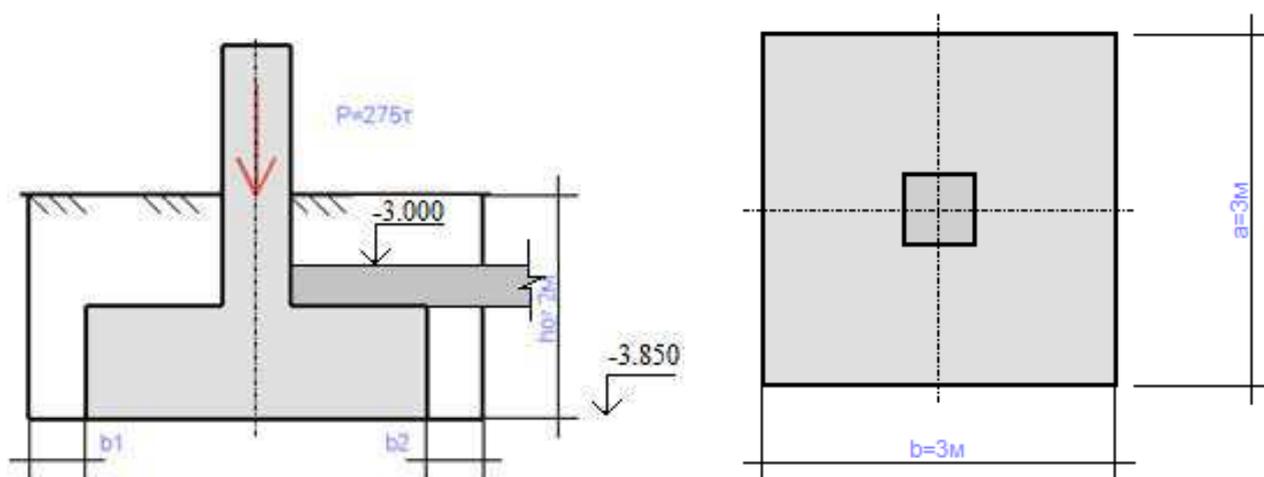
Конструктивное решение фундамента Фк-3
